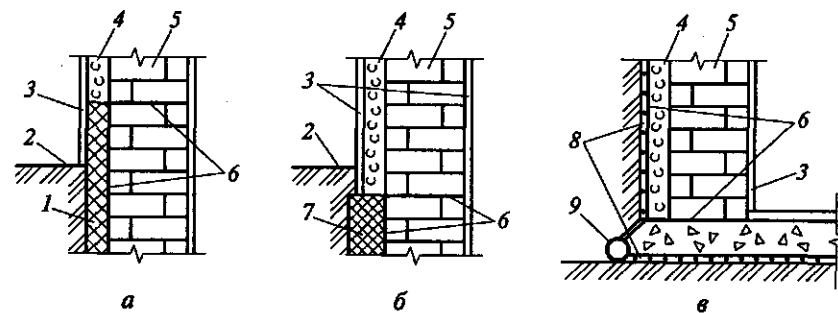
Гидротеплоизоляционная защита подземной части здания:
